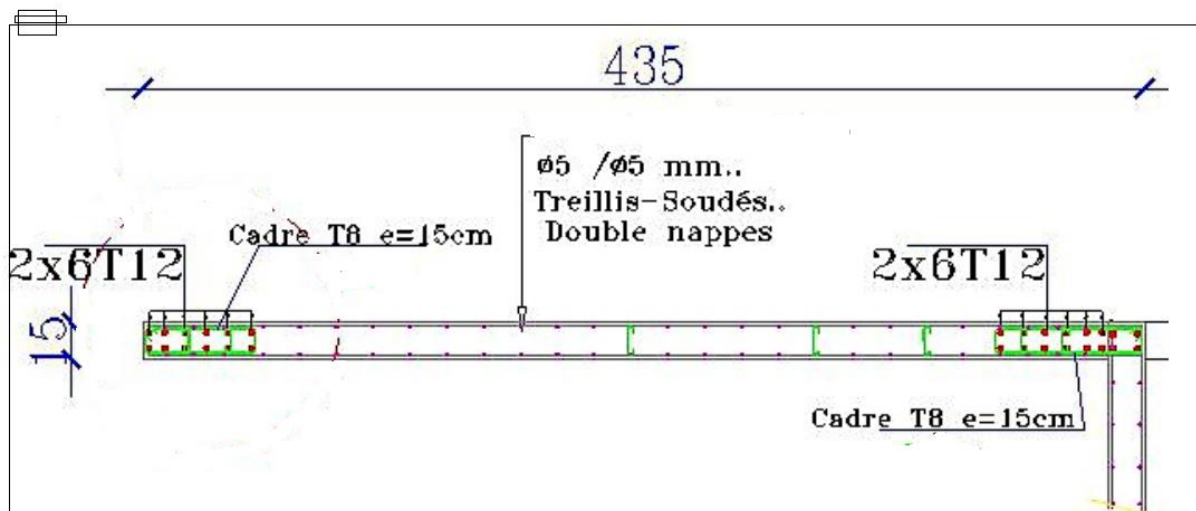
Ferrailage des voiles ue en plan VY(2, 15)
